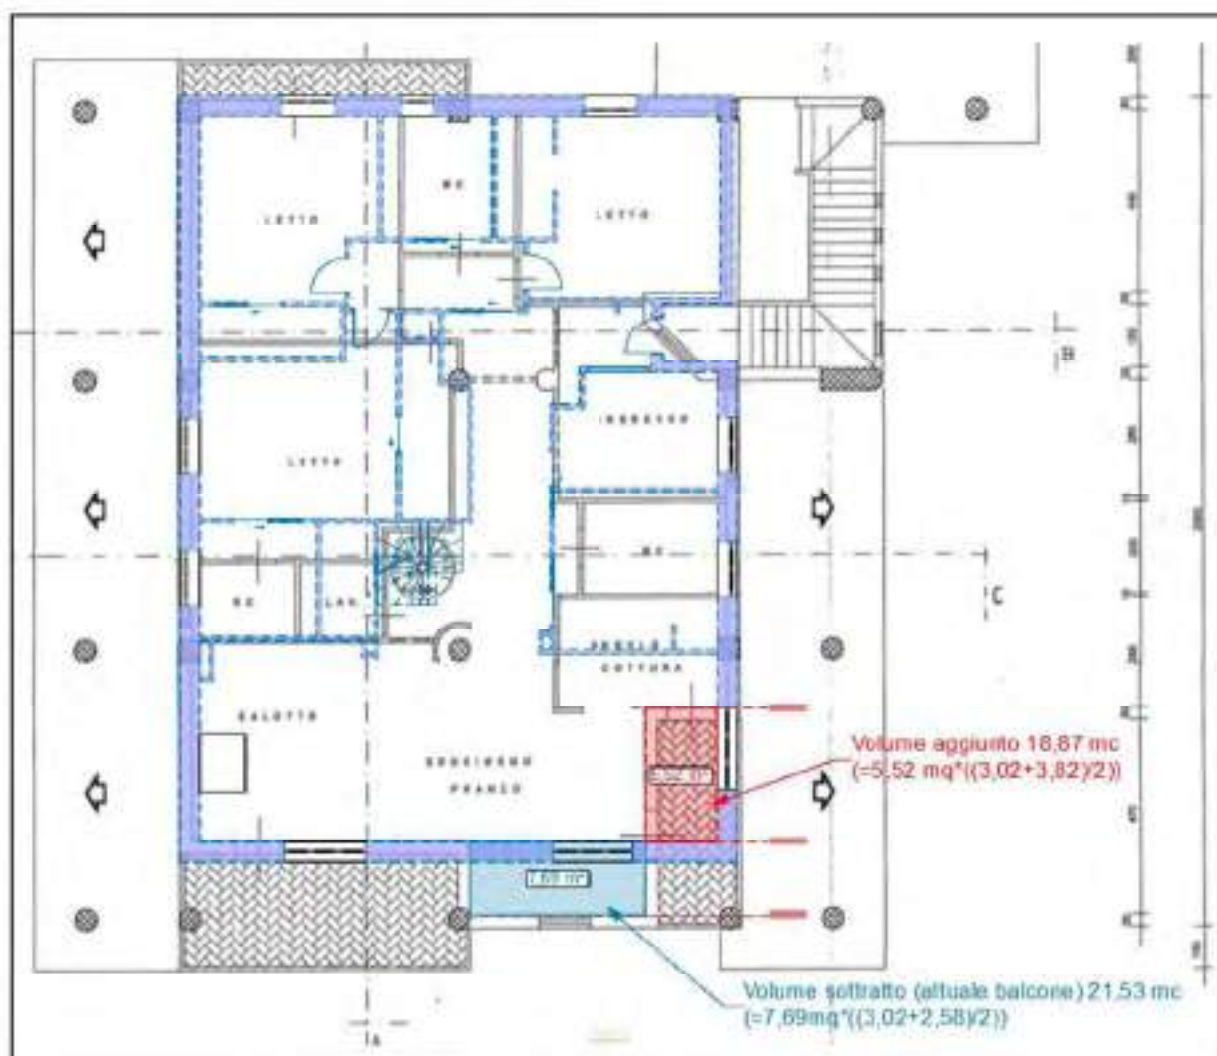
Pianta piano primo allegata al progetto approvato con concessione edilizia prot. 11322 del 07/11/1996 con indicazione delle difformità rilevate all'interno del sub 6 (in blu sono indicati i muri attualmente presenti).
